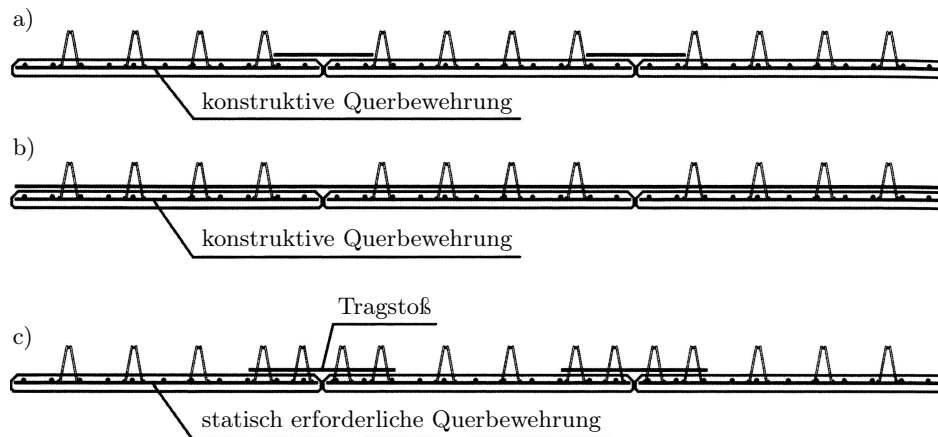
Bewehrungsanordnung in Elementdecken (Furche und Bauermeister 2009)
